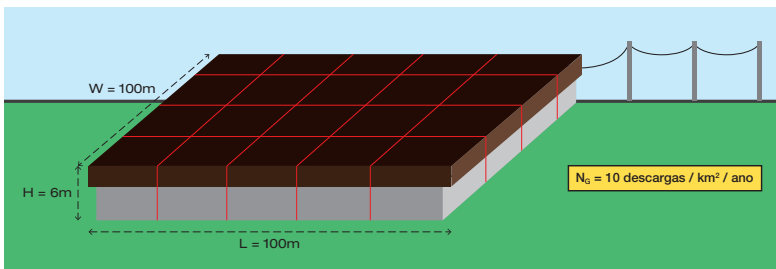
Estrutura horizontalizada com grandes dimensões em planta.
